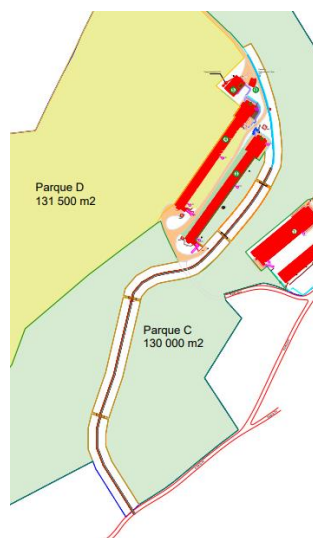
Extrato da Planta Síntese da Exploração - Fonte: Anexo C.Planta Síntese da Exploração
